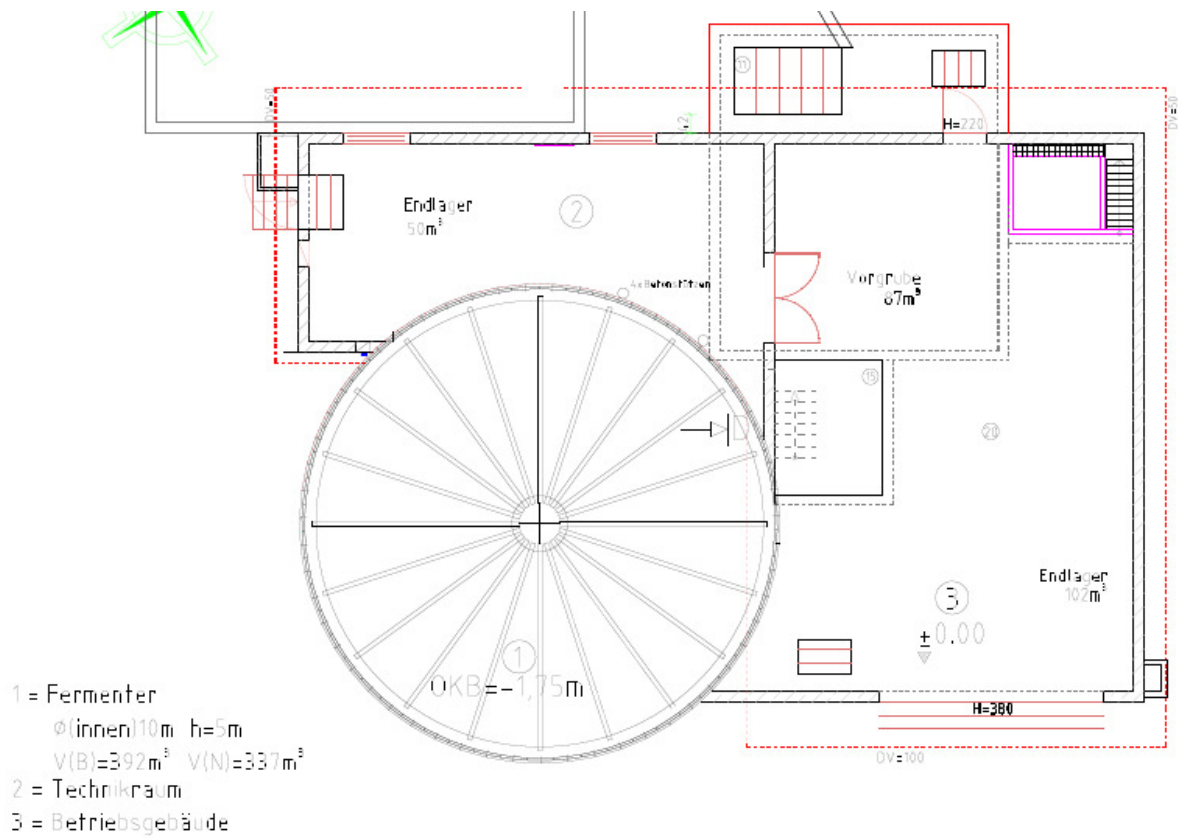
Grundriss der Biogasanlage in Silaplana (Genesys GmbH)
